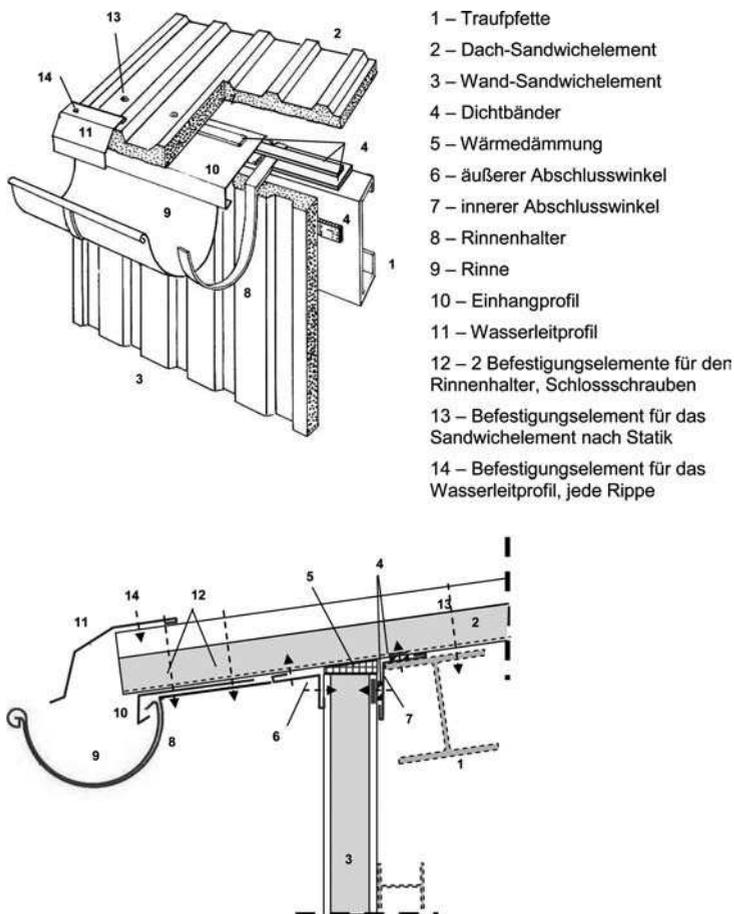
Traufausbildungen bei Deckungen mit Sandwichelementen, unten: Traufausbildung bei Dachüberstand
